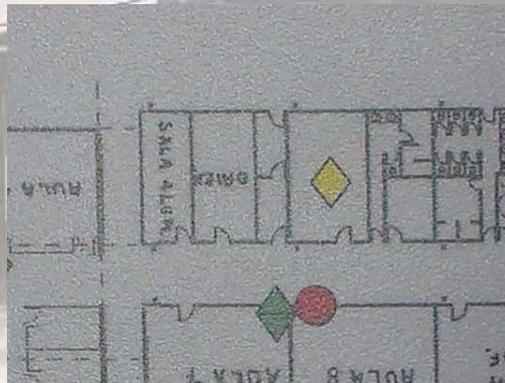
Ubicación extintor según Plan de Autoprotección del centro. Fuente: Fotografía de la autora
